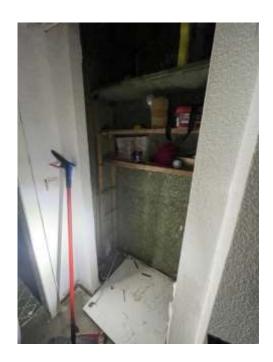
Abstellkammer Wohnung Roonstraße 69 2.0G links
